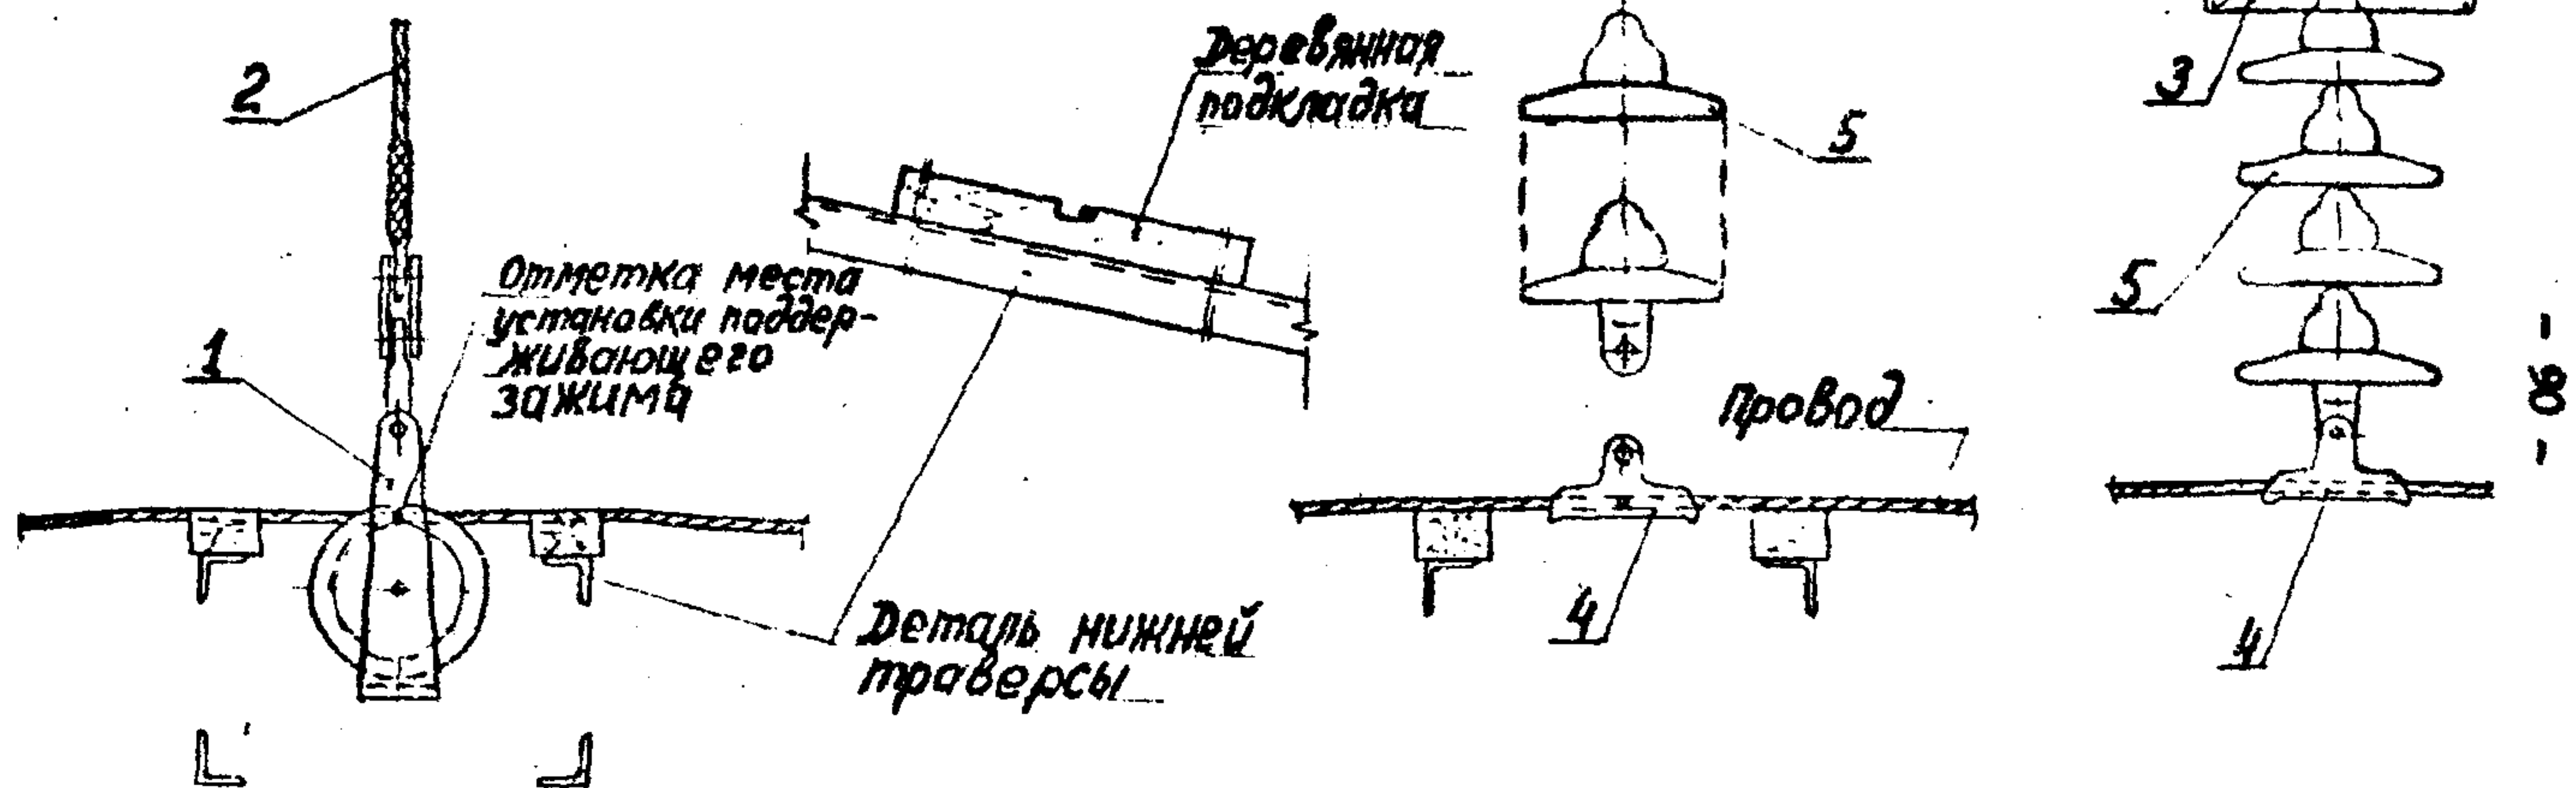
Узел А. Перекладка провода верхней траверсы с опусканием на нижнюю траверсу опоры
